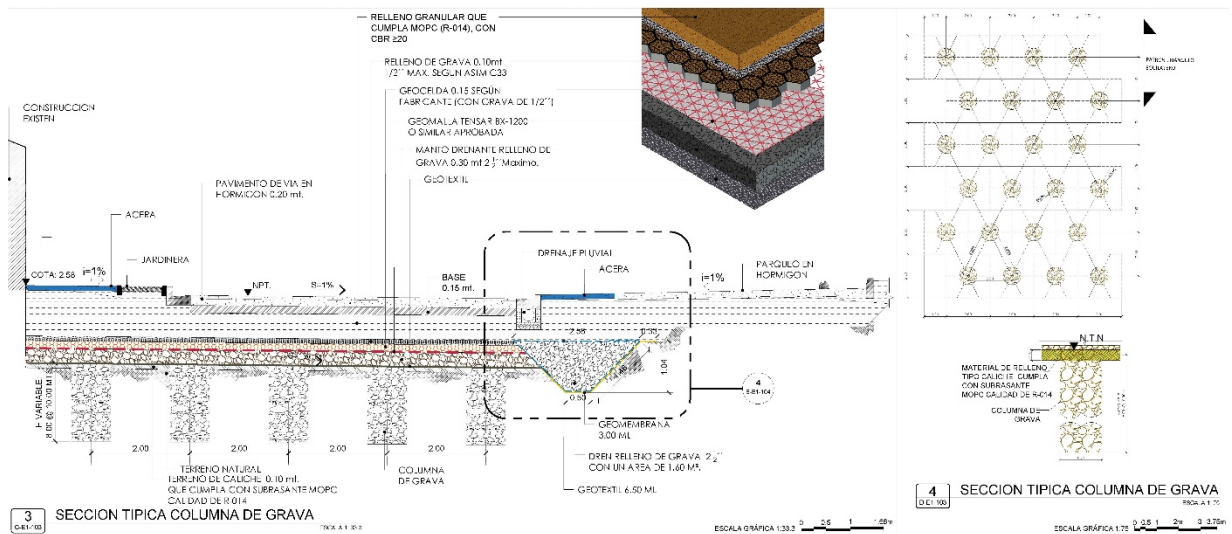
Detalle de construcción de columnas de grava. Fuente: URBE, octubre 2025.
